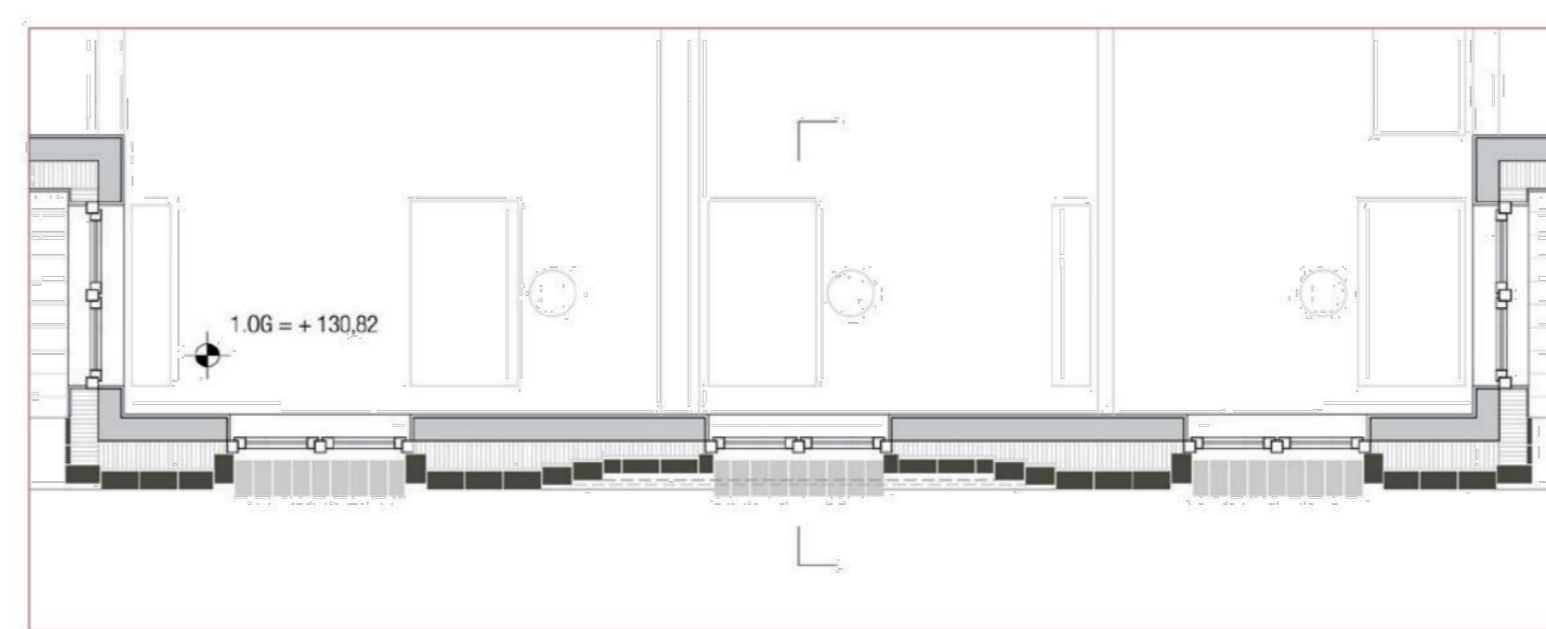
DETAILANSICHT WALTER-HALLSTEIN-STRASSE 1:50
